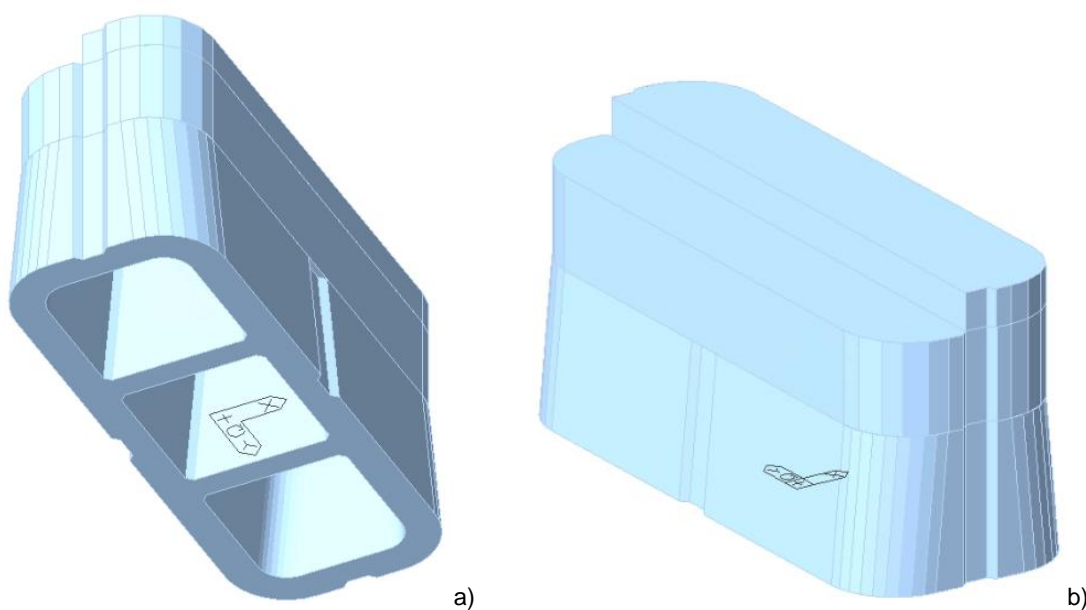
Modellazione tridimensionale agli Elementi Finiti – a) Vista 3D dal basso b) Vista 3D dall'alto – Pila P15
